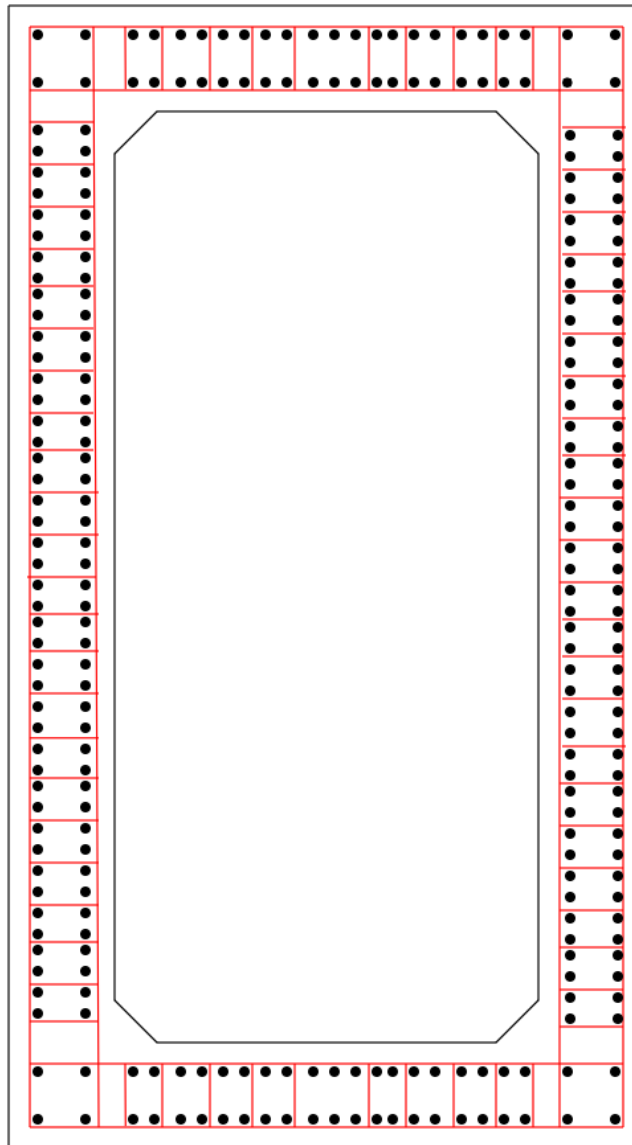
Distribución del refuerzo longitudinal y transversal de la pila
